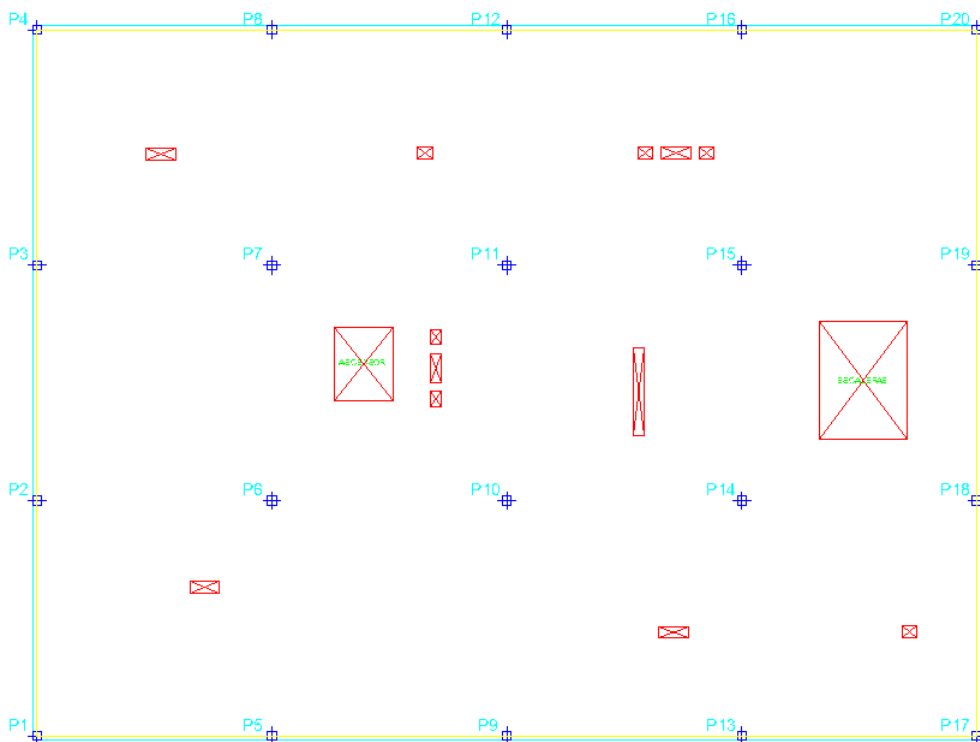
Vista en planta del replanteo de planta baja
